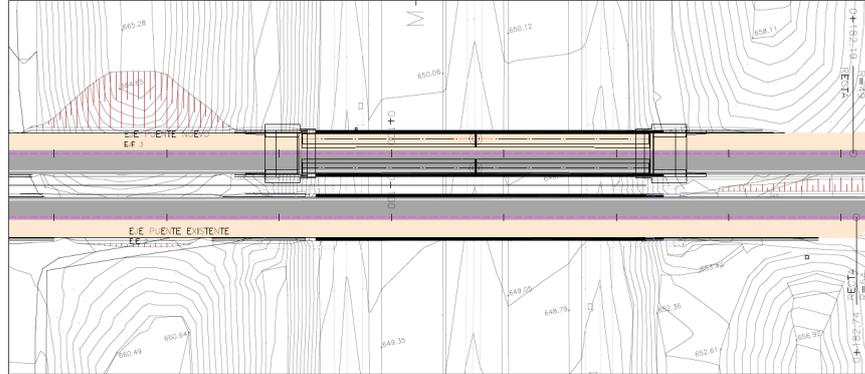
Esquema en planta del acondicionamiento y duplicación propuestos.
